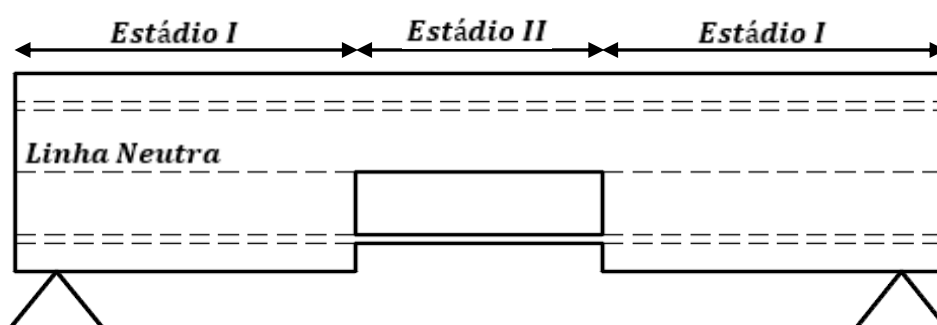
Condições dos estádios da viga de concreto armado. Fonte: O Autor (2016).
